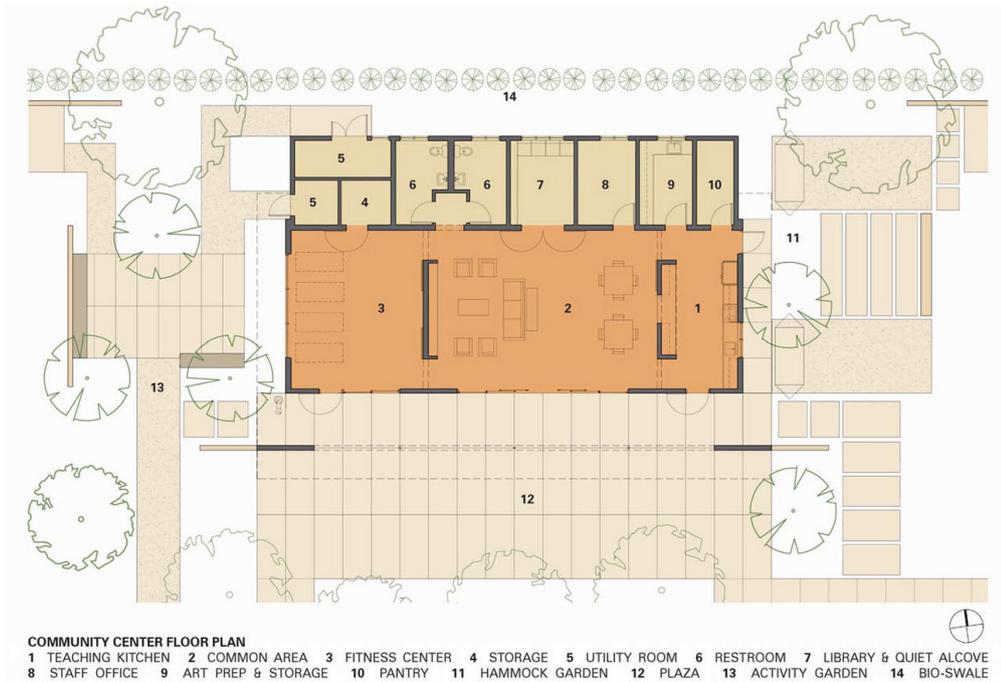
Pianta piano terreno (Fonte: Archdaily).
